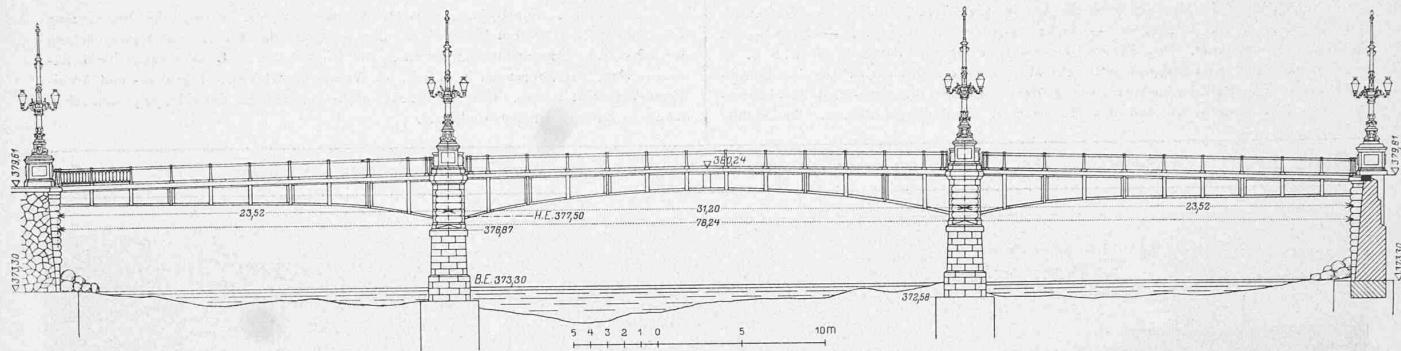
Elevation du nouveau pont des Acacias. — Echelle 1:400.
